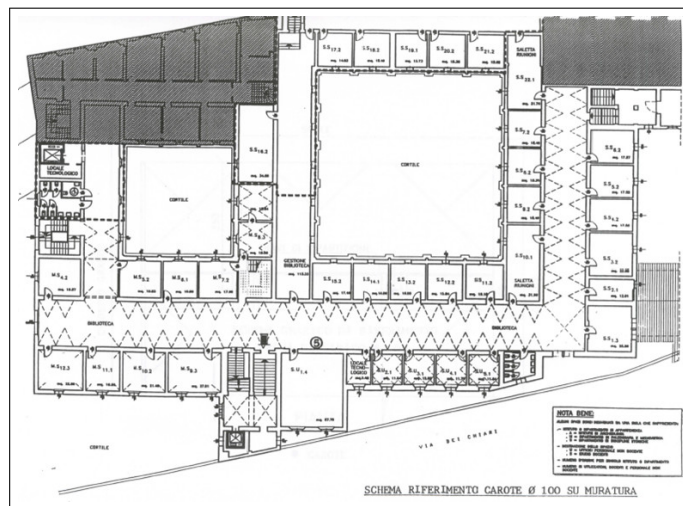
Ubicazione dei prelievi carote al piano secondo.
